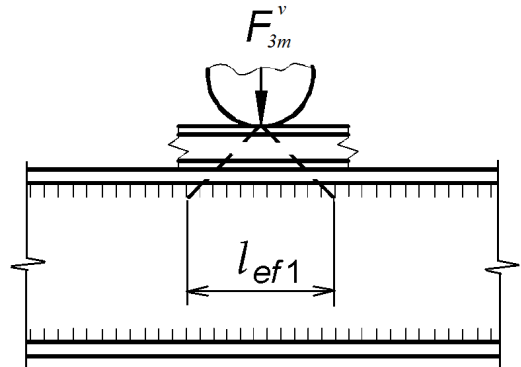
Схема передачі зосередженого навантаження на стінку головної балки
